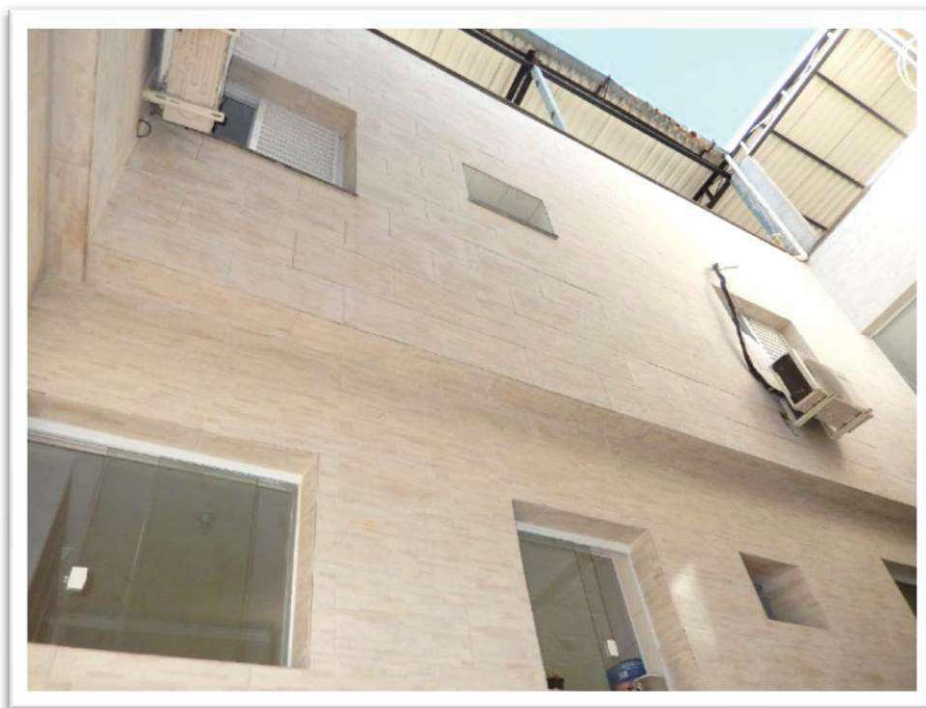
Vista parcial da fachada lateral esquerda do Imóvel 1.
